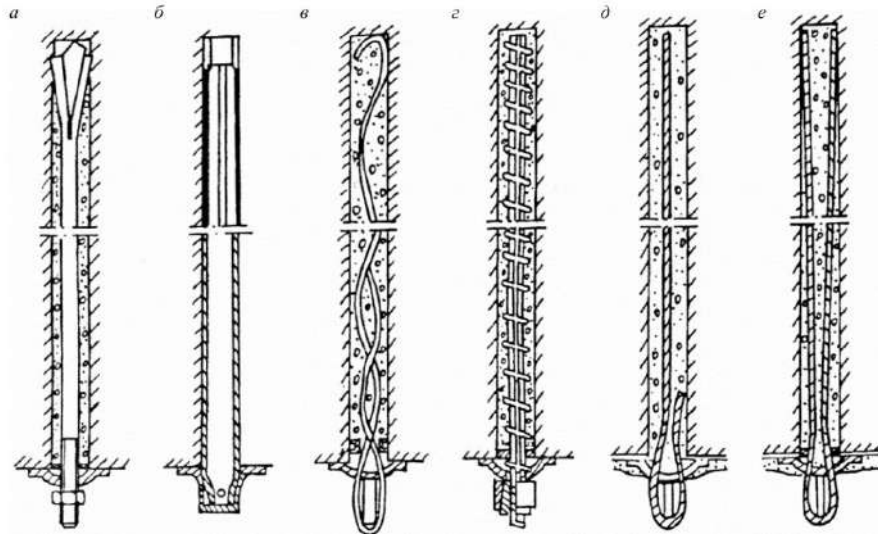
Конструкции сейсмостойких анкеров: а – комбинированный железобетонный; б – трубчатый гидрораспорный; в – трособетонный; г – сталеполимерный с универсальным опорным элементом; д, е – одно- и двухстержневой железобетонный с клиновым опорным элементом [20]
